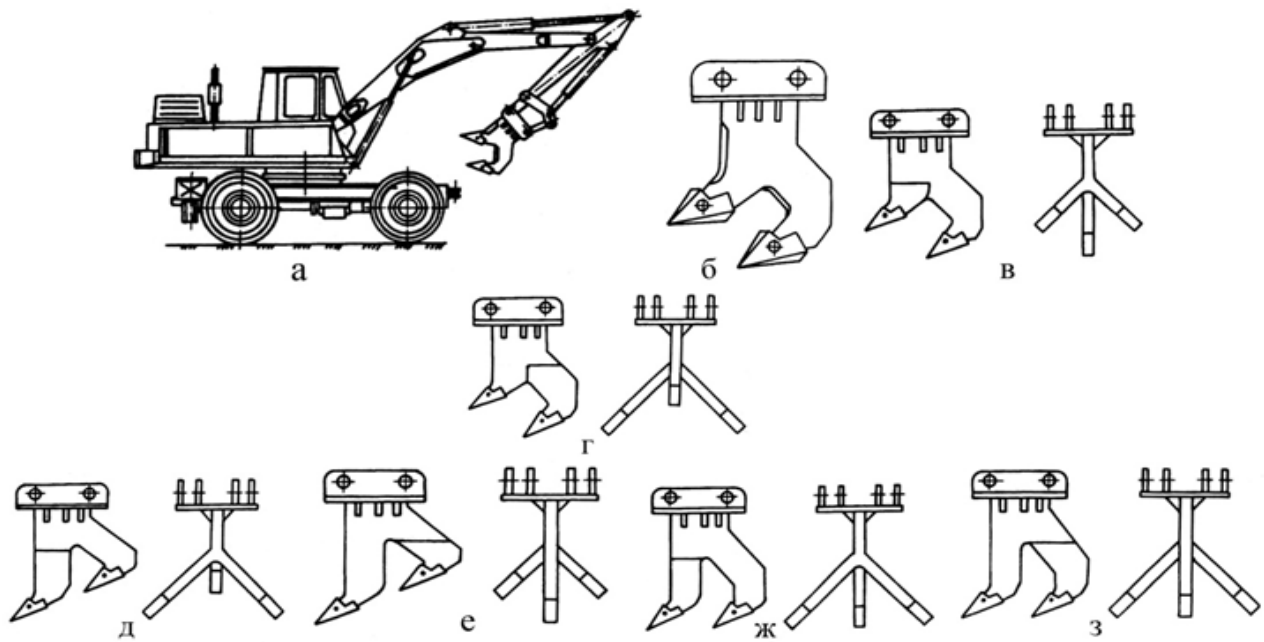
Рыхлительное рабочее оборудование к гидравлическому экскаватору:
